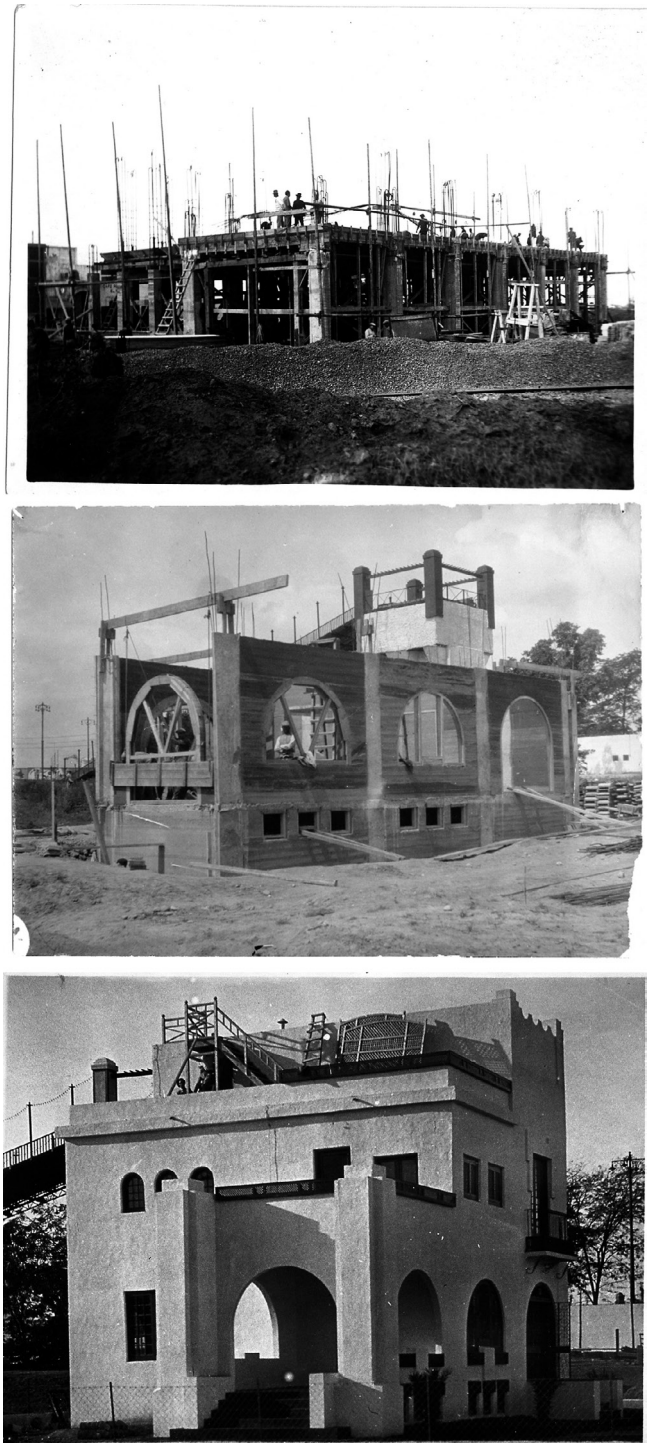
Imágenes de la construcción Nor-Tor de la casa Conde de Mejorada, Sevilla, 1928. Fuente: Archivo ETM.
